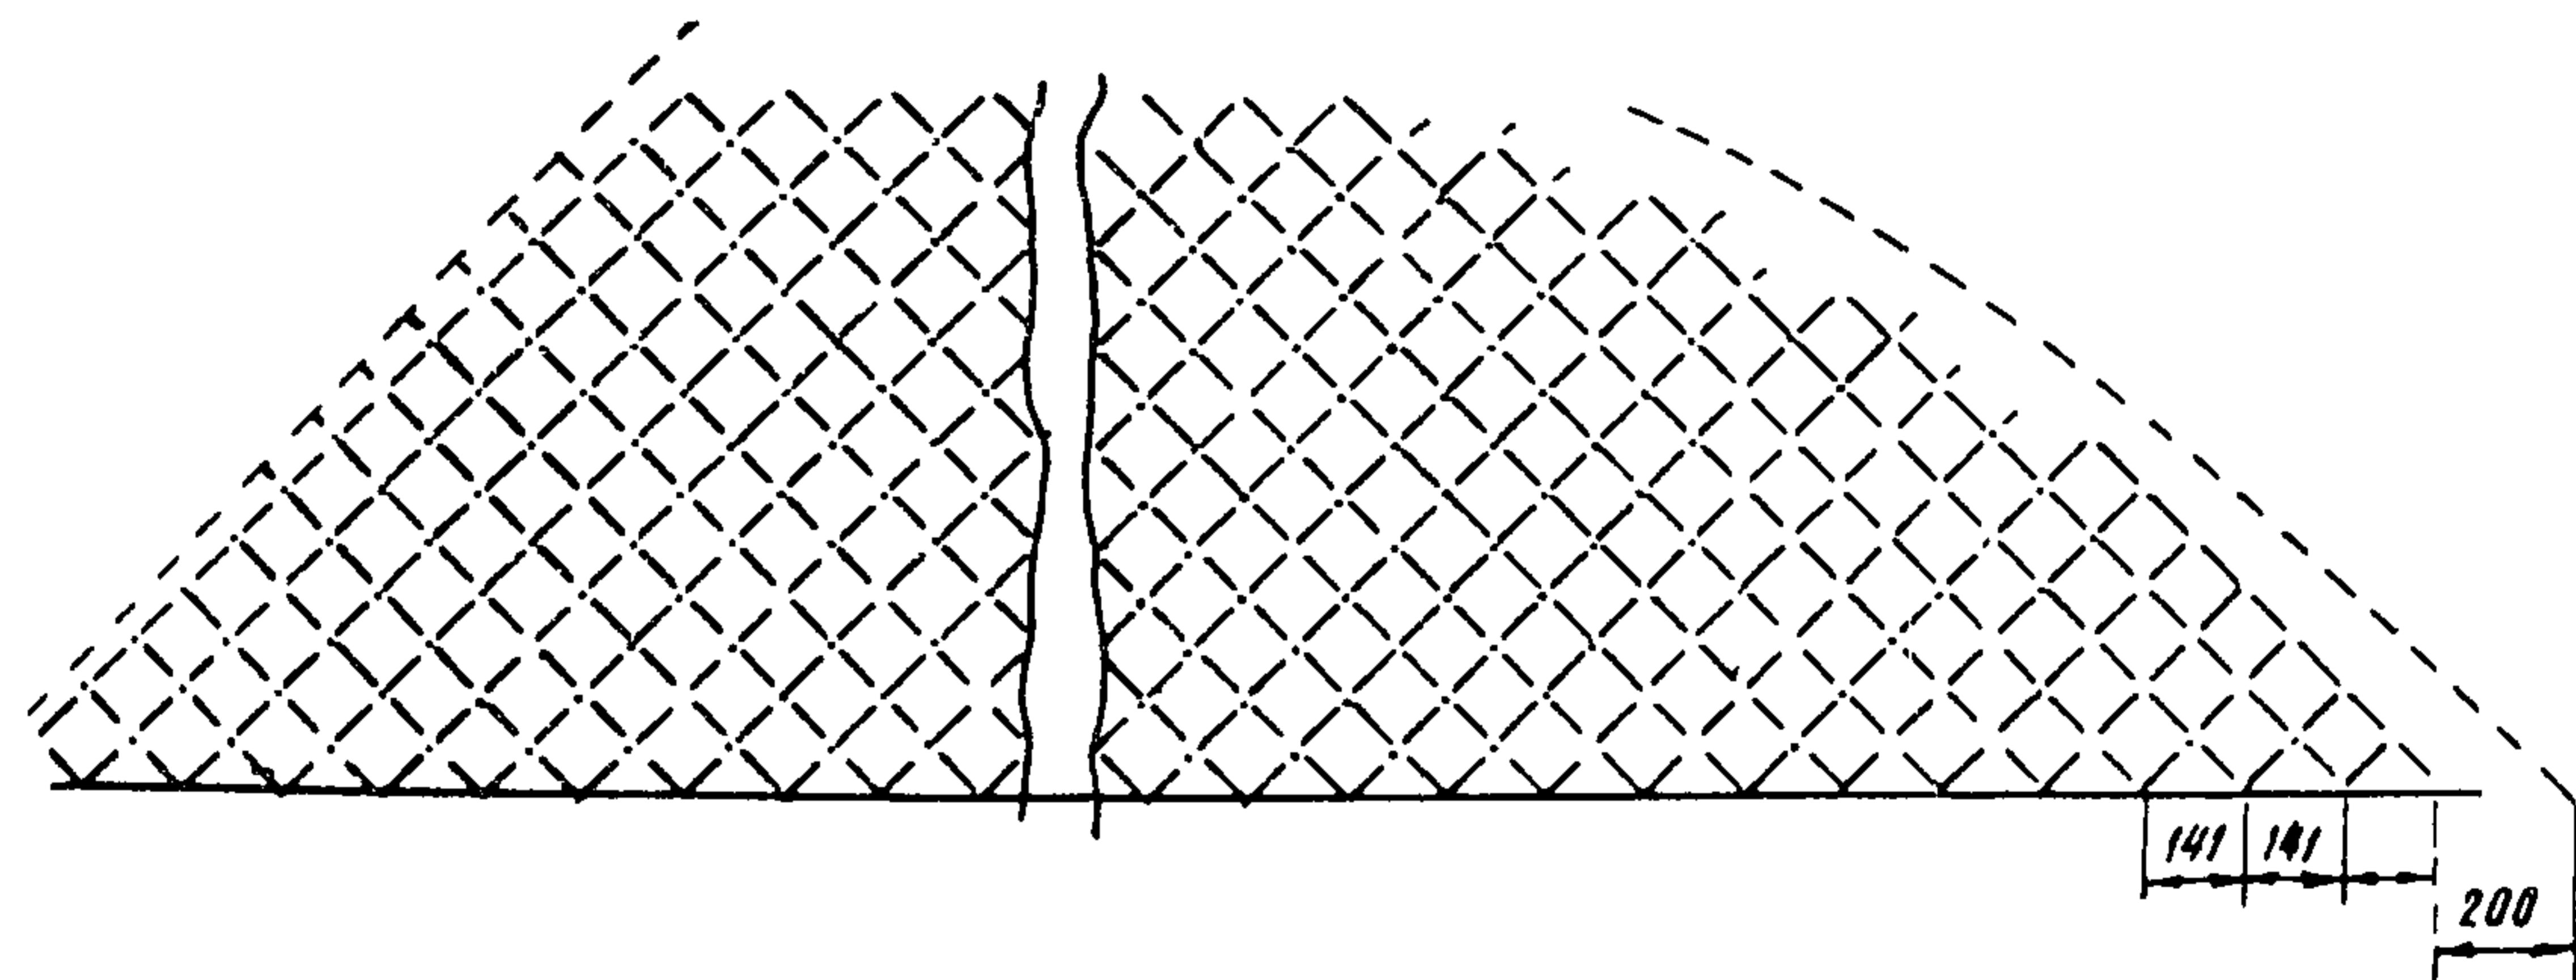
Разбивка откоса выемки под укладку сборных элементов
